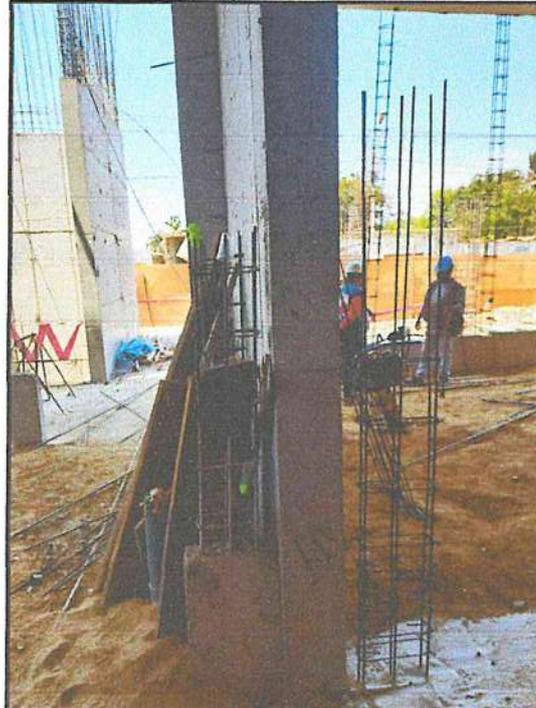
Columneta a medio vaciar sin junta de dilatación
